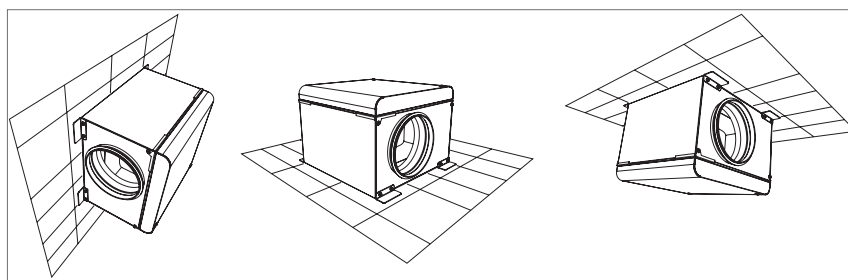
Montaggio a parete, pavimento o soffitto
